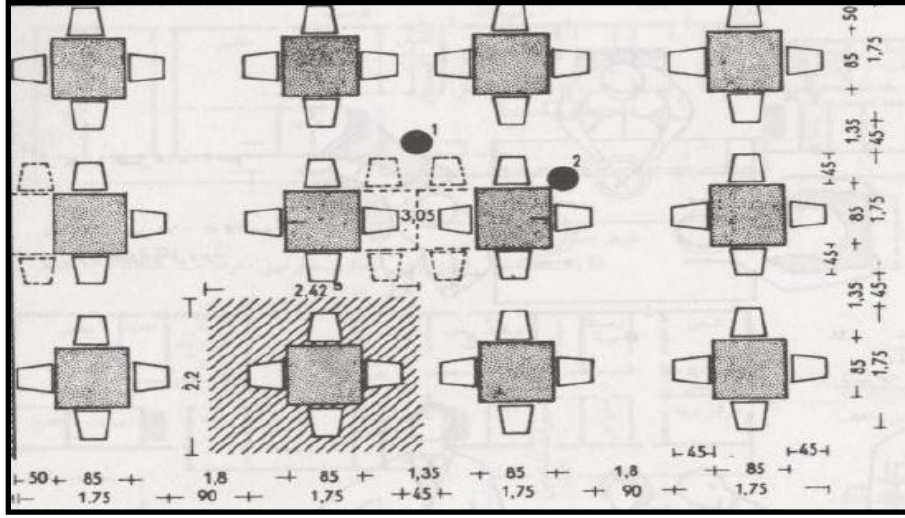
/ ٣ أبعاد طاولة المكتب بشكل أفقي / المصدر: Design -Tech (Building Science for Architects)
